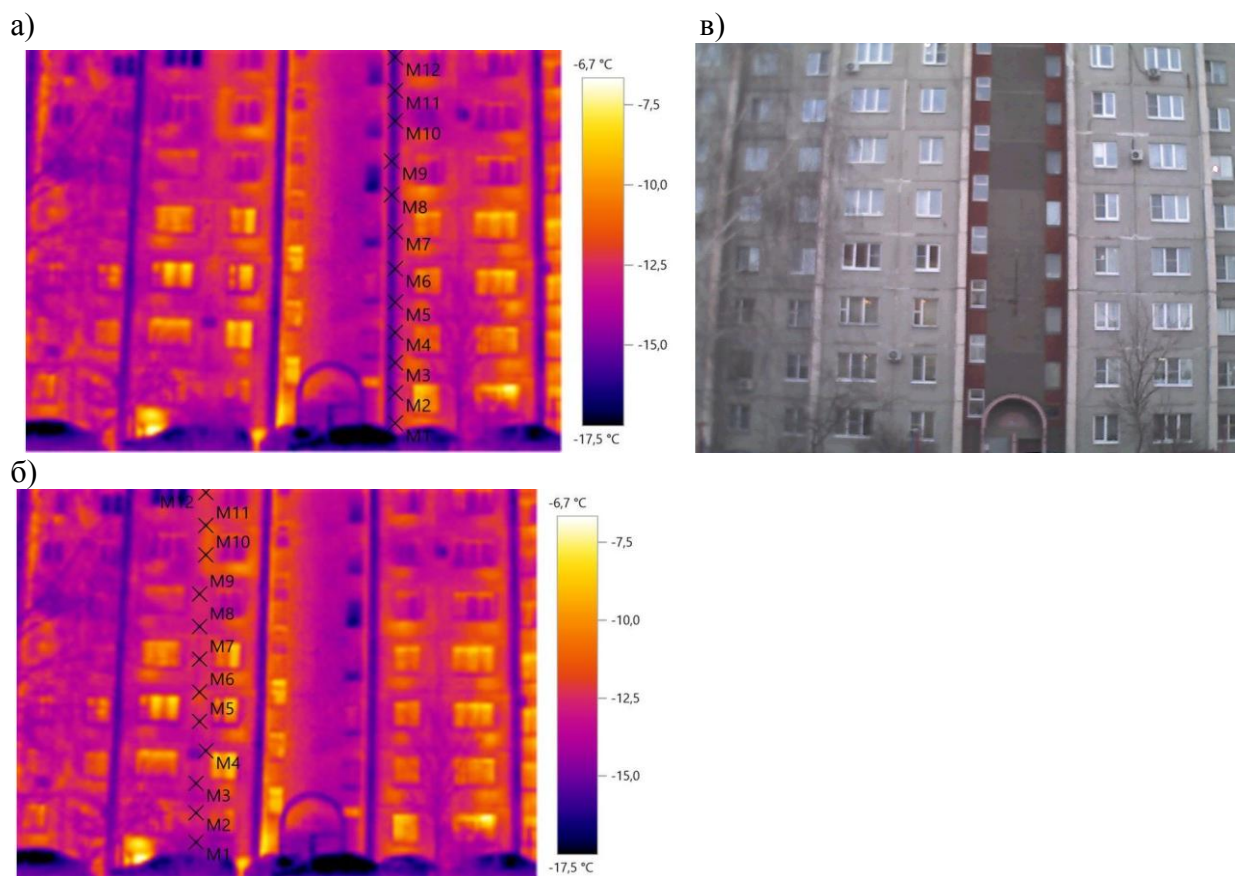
Натурные исследования северного фасада здания, подъезд 3:
